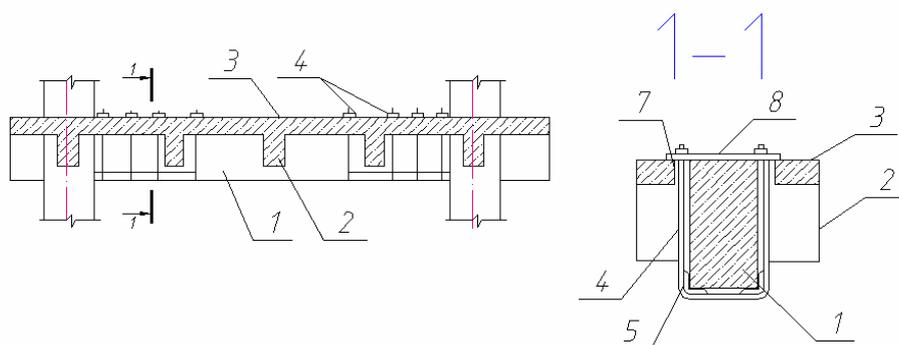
Усиление главных балок монолитного железобетонного перекрытия установкой стяжных хомутов на опоре: 1 – усиливаемая главная балка; 2 – второстепенные балки; 3 – плита; 4 – металлические стяжные хомуты с гайками; 5 – прокладка из уголка; 6 – прокладка-шайба; 7 – отверстия, просверленные в плите для пропуска хомутов; 8 – металлическая планка
